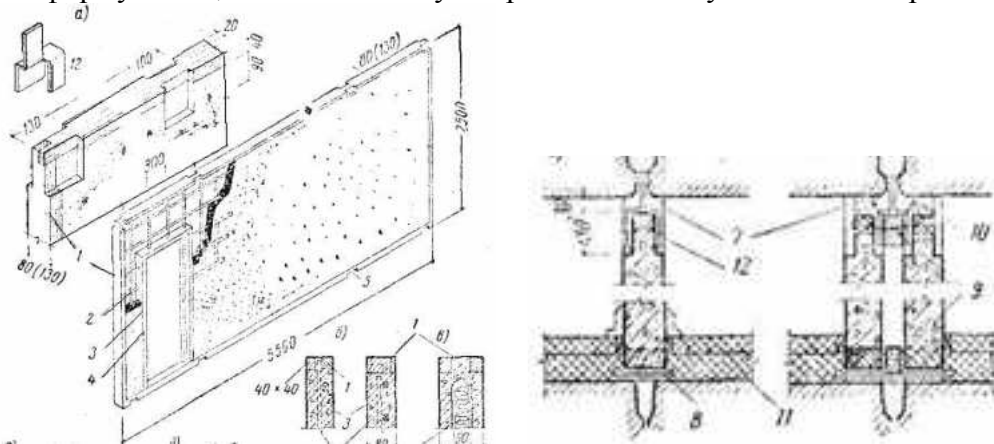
Гіпсобетонна крупнопанельна перегородка: загальний вид, варіанти перетину, примикання одношарової перегородки до стіни
